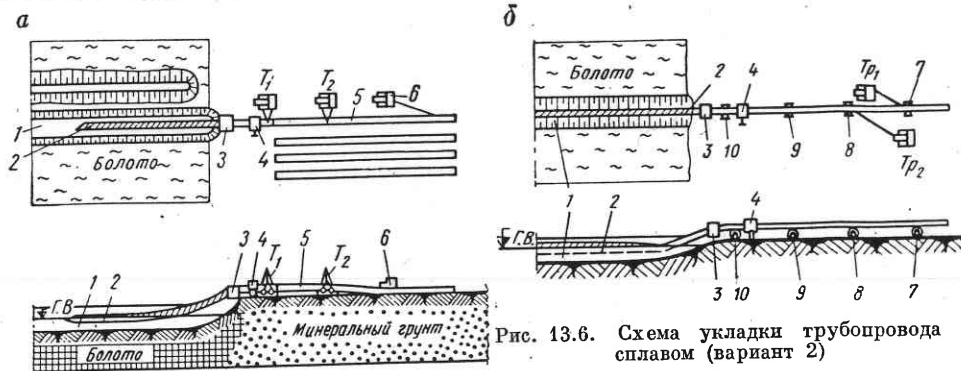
Схема укладки трубопровода сплавом (вариант 2)
